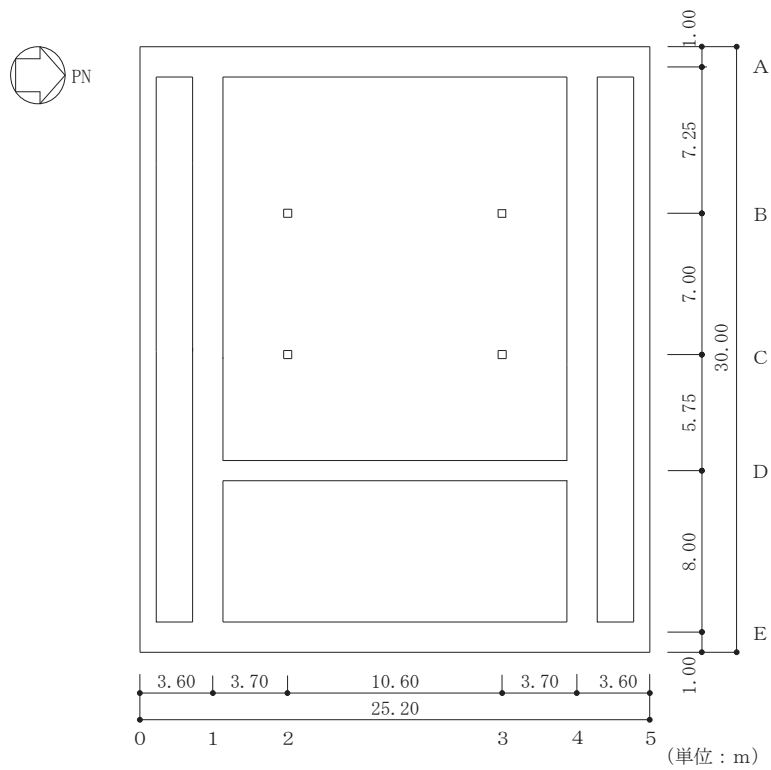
(1) 緊急用電気品建屋の概略平面図(0. P. * 56. 4m)
